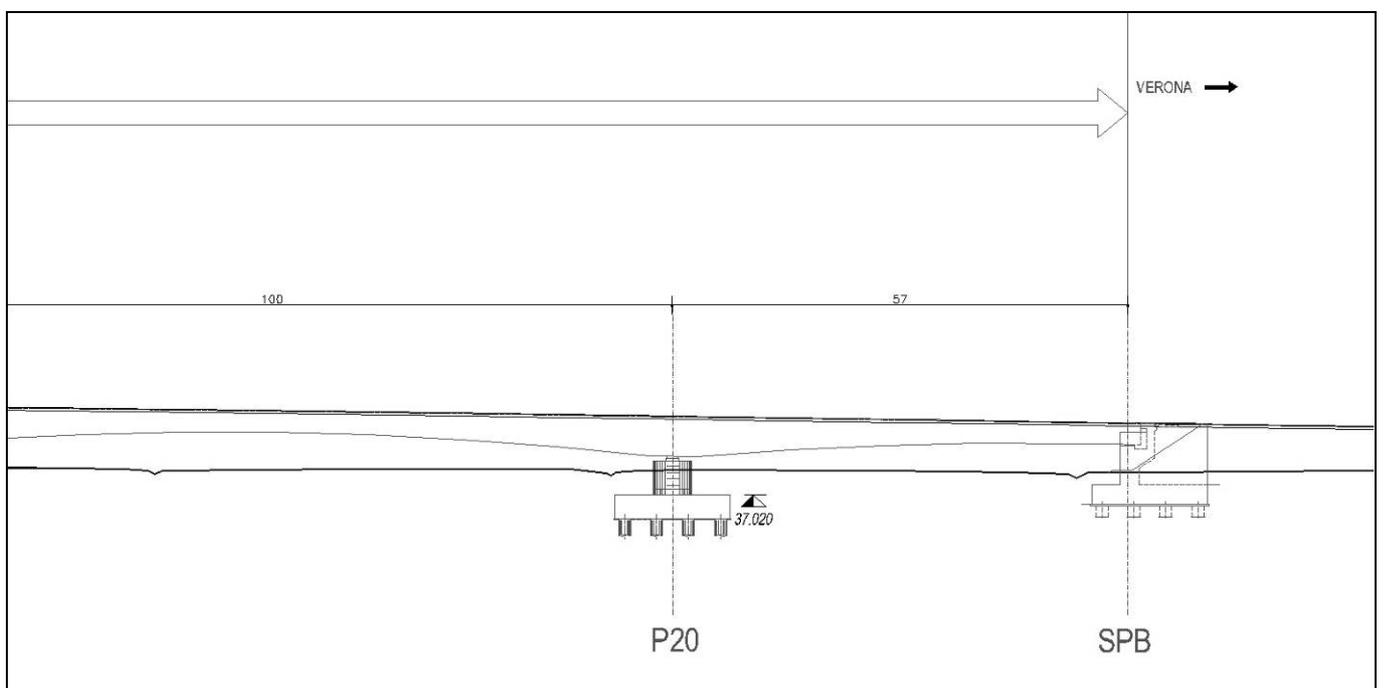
Profilo longitudinale del Progetto Esecutivo del Ponte sul Fiume Taro nel tratto delle spalle nord.
